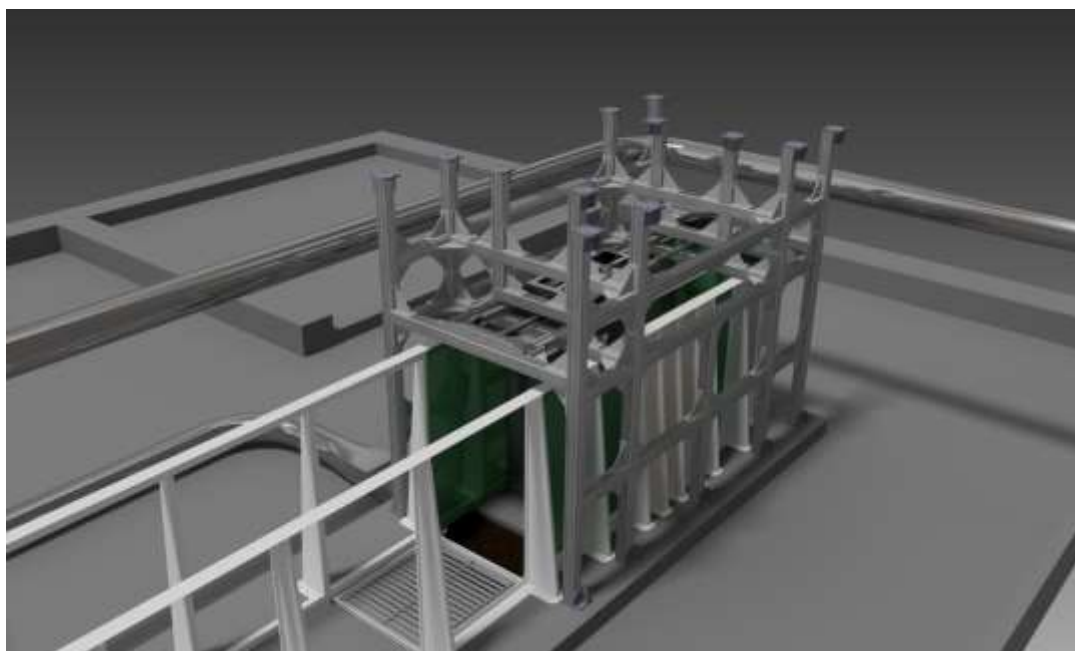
Остъклена конструкция на ВК и хидроизолиран под.
